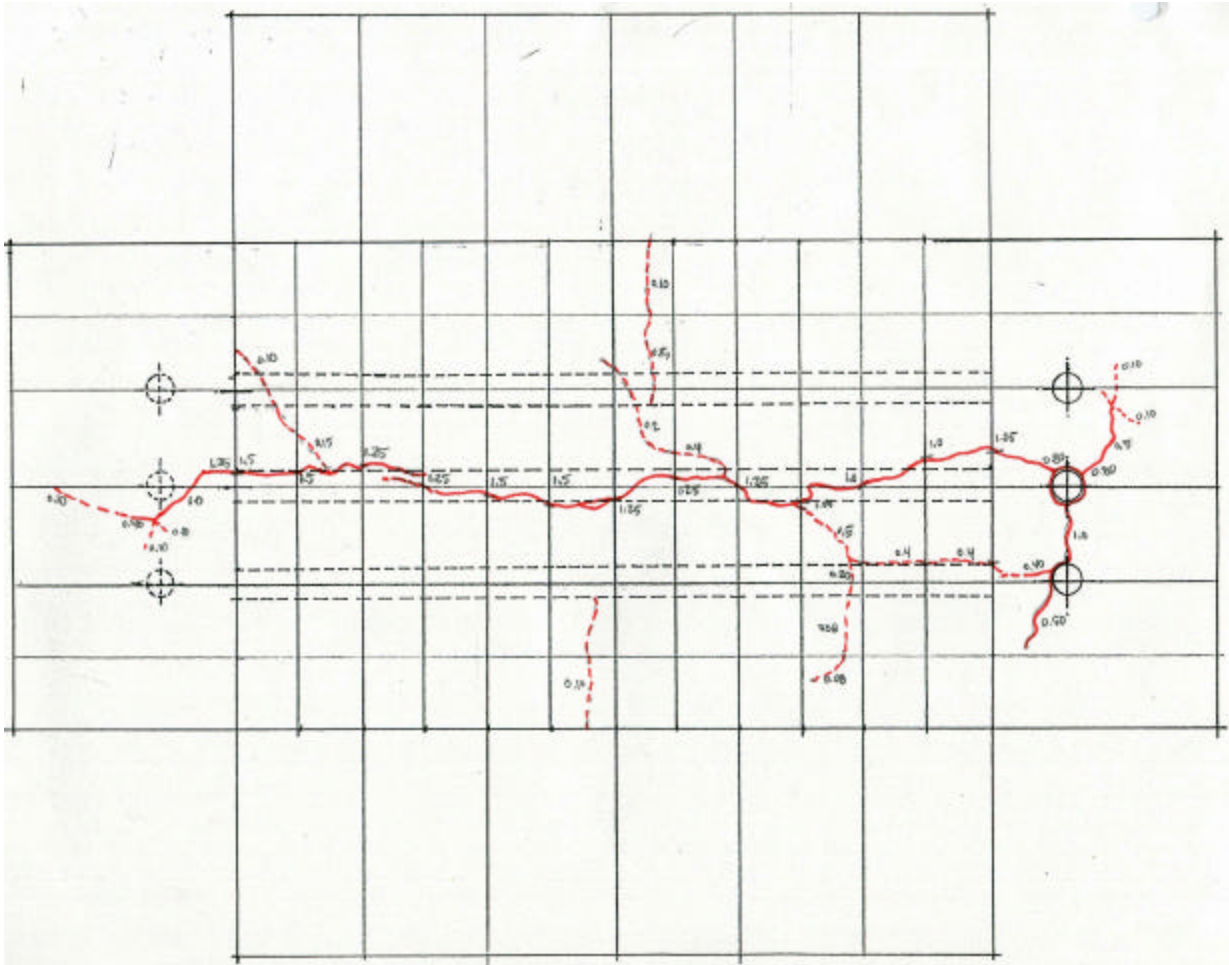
Ejemplo del levantamiento de grietas (Prisma A06)
